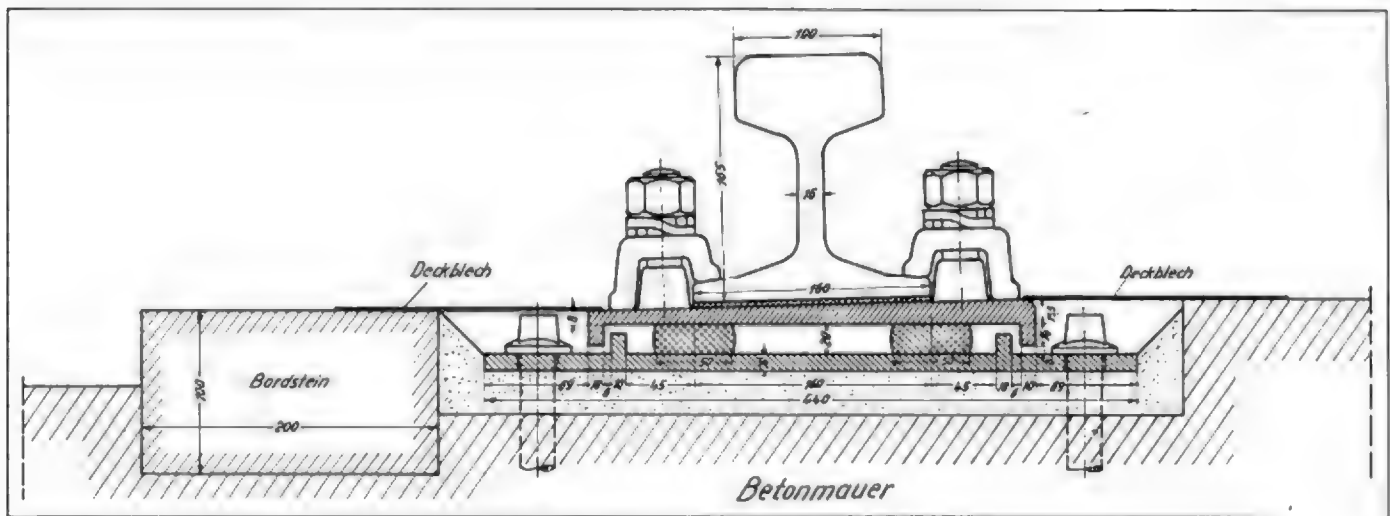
Schwingplattenoberbau mit Gummifederung (Langschwellen) für Breitspur-Fernbahnen.
